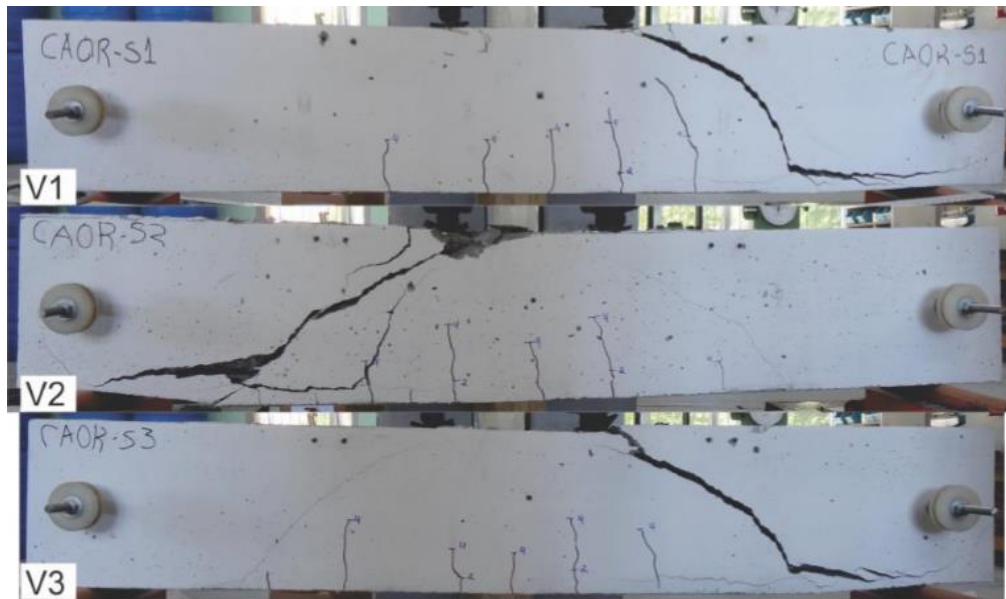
Vigas de concreto CA0R sem armadura transversal após ruptura, ensaiadas por Savaris (2016).
